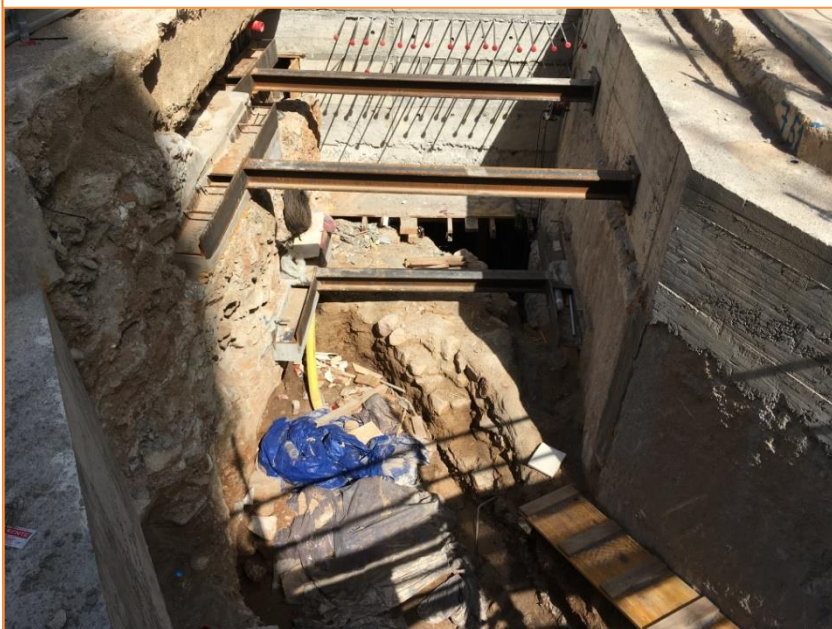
Vista de l'estat del jaciment després de fer la llosa.
